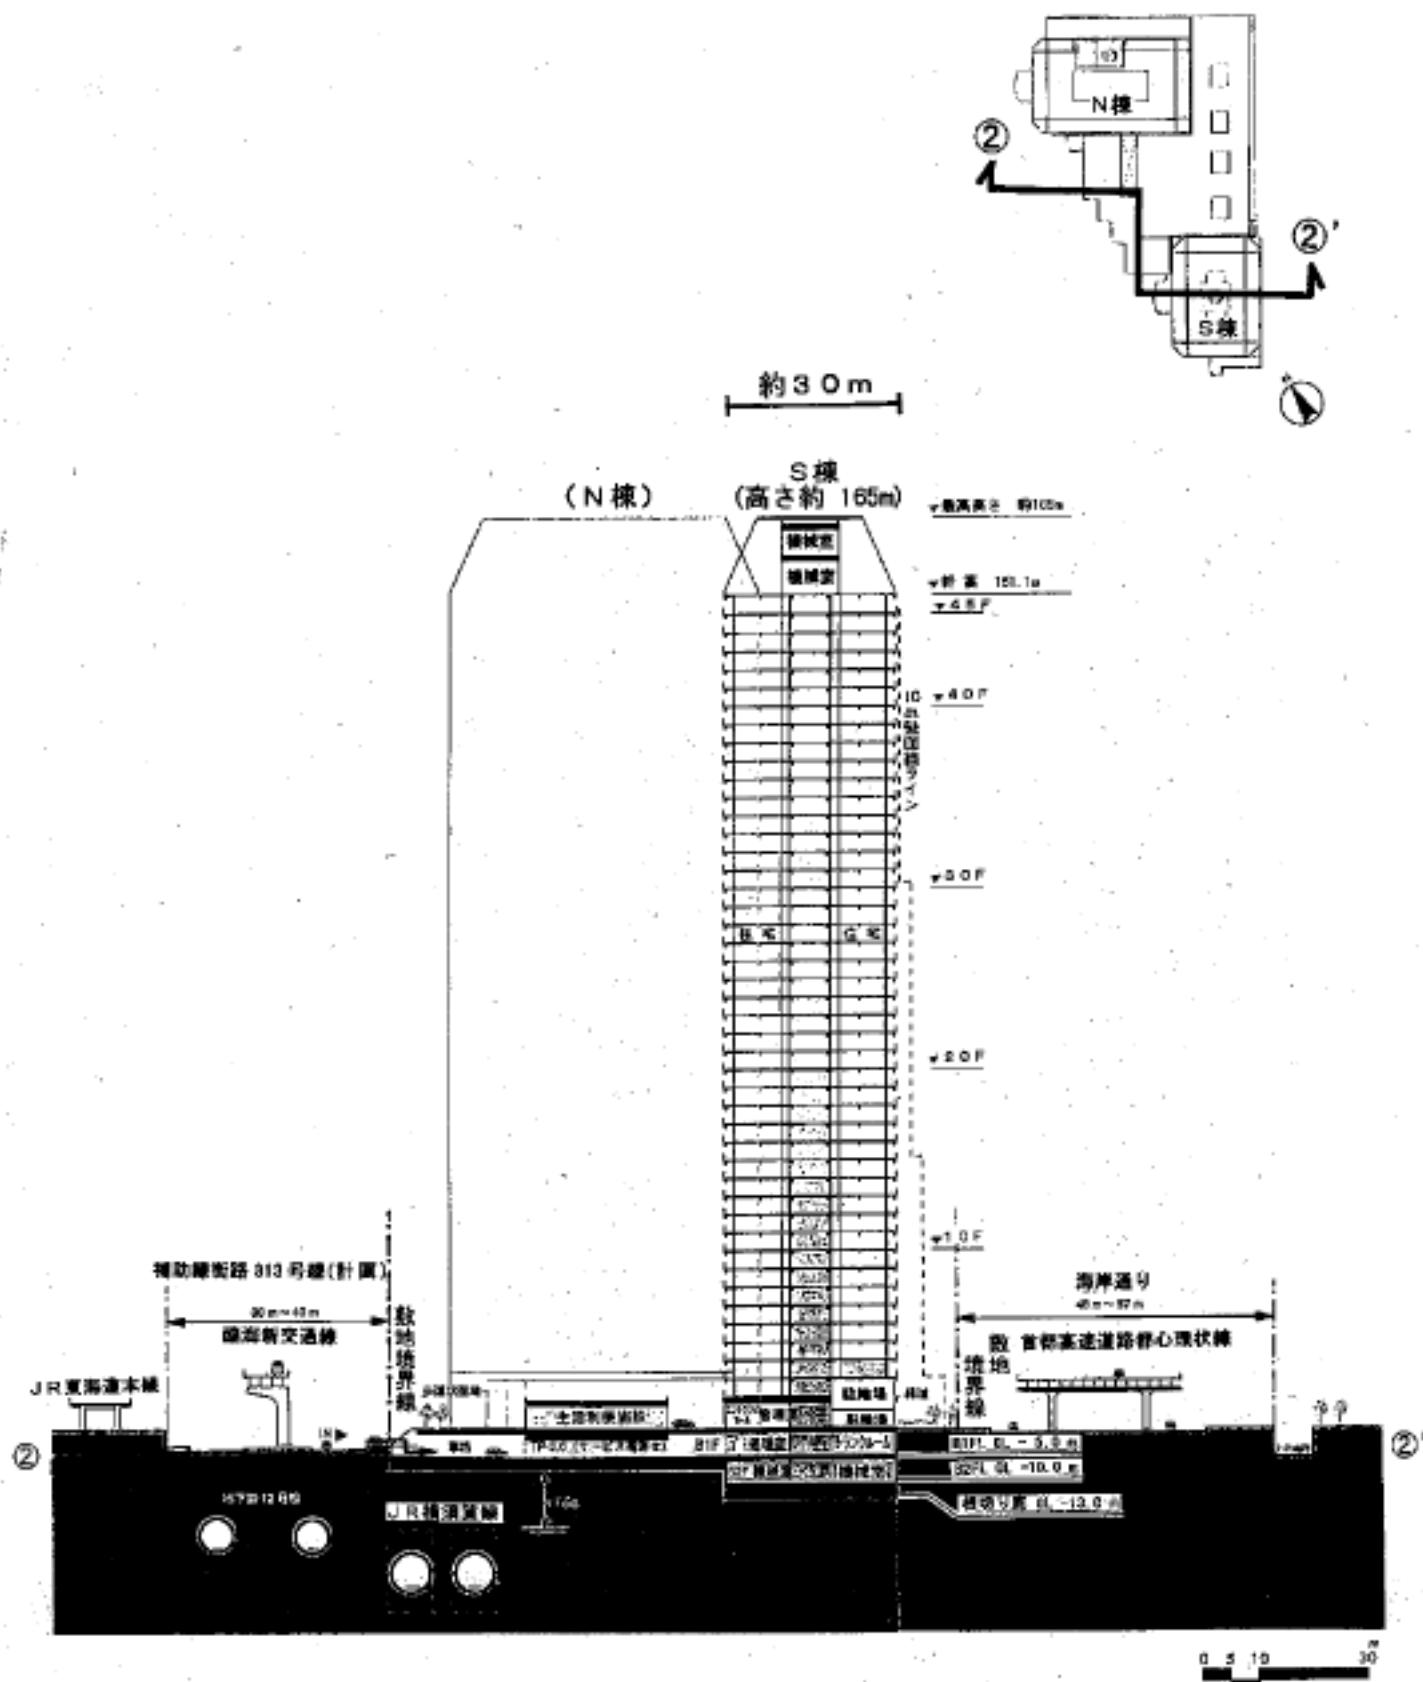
(2) 计画建筑物断面图 (②-②'断面)
